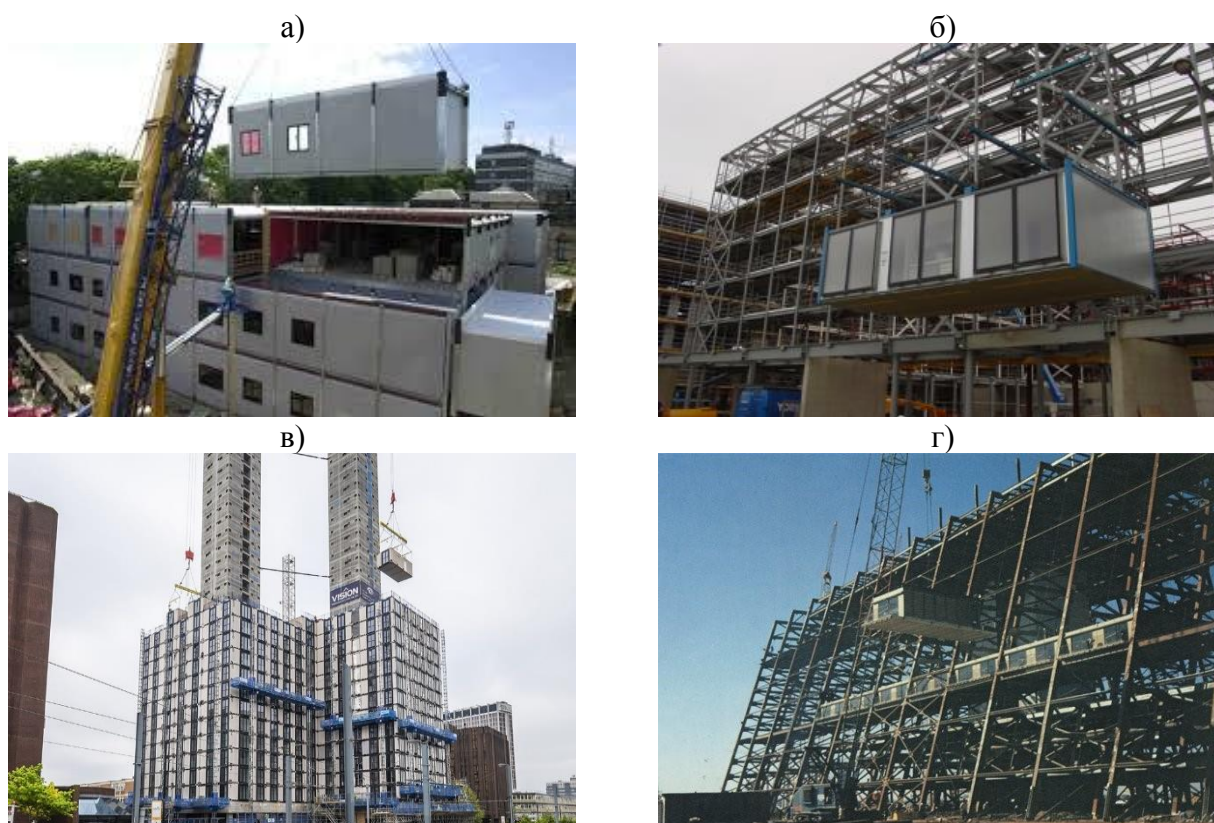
Конструктивные схемы модульных зданий: а) из составных модулей (https://www.steelconstruction.info/Modular_construction); б) со стальным ядром жесткости [19]; в) с железобетонным ядром жесткости [23]; г) с внешним каркасом [23]
